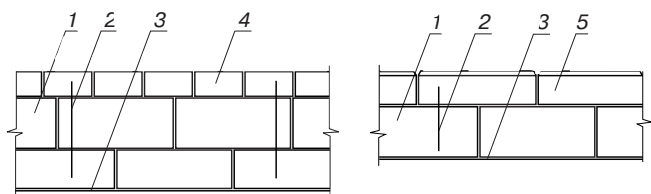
Конструктивные решения стеновых ограждающих конструкций из поробетонных блоков: 1 – блоки из ячеистого бетона плотностью 500 кг/м³; 2 – стеклопластиковые связи; 3 – гипсокартонные листы; 4 – керамический облицовочный или силикатный кирпич; 5 – плиты теплоизоляционные из пеноволокнита плотностью 300 кг/м³ с фактурным слоем
